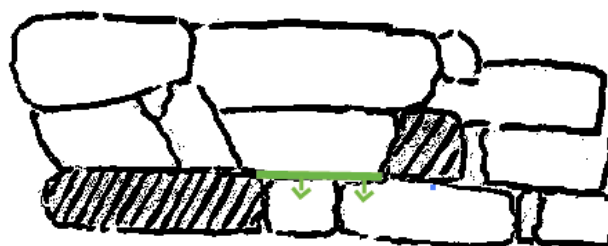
Exemple d'une pierre qui fait appui sur deux autres - Août 2018
